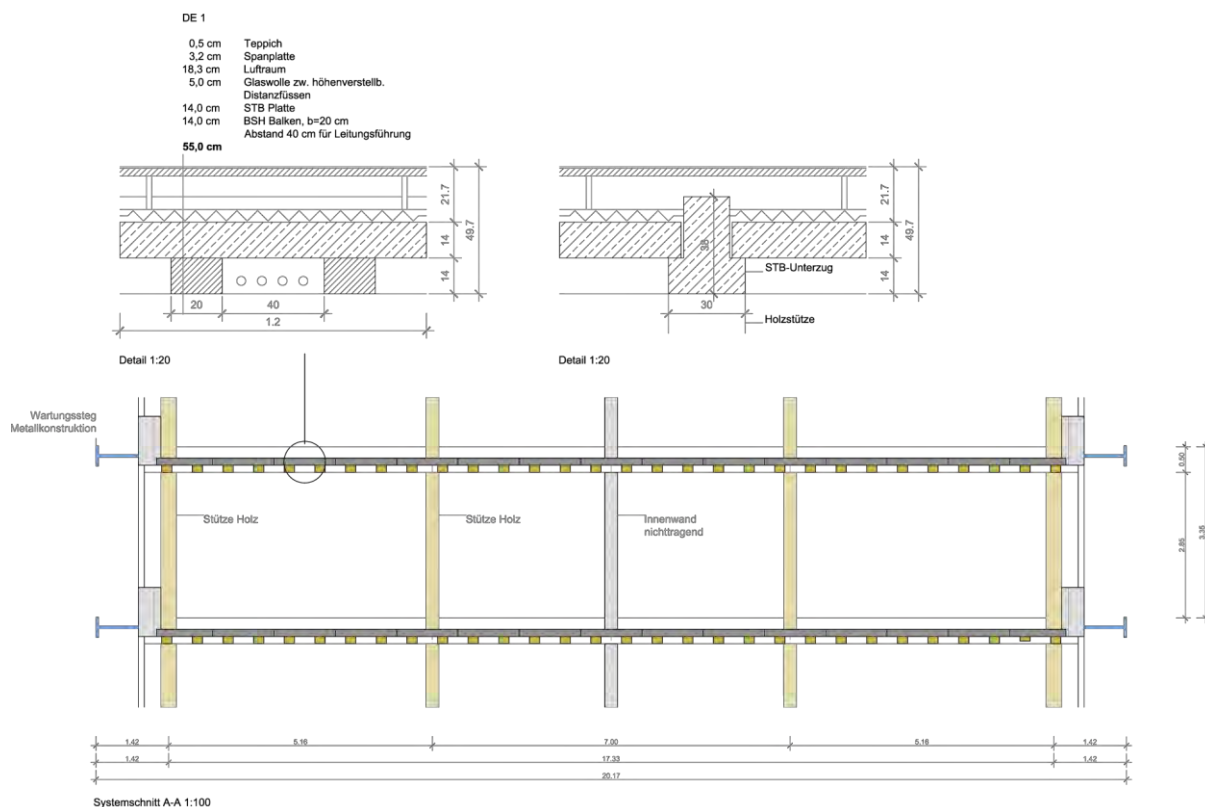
Tragstruktur Holz-Stahlbeton-Verbund
